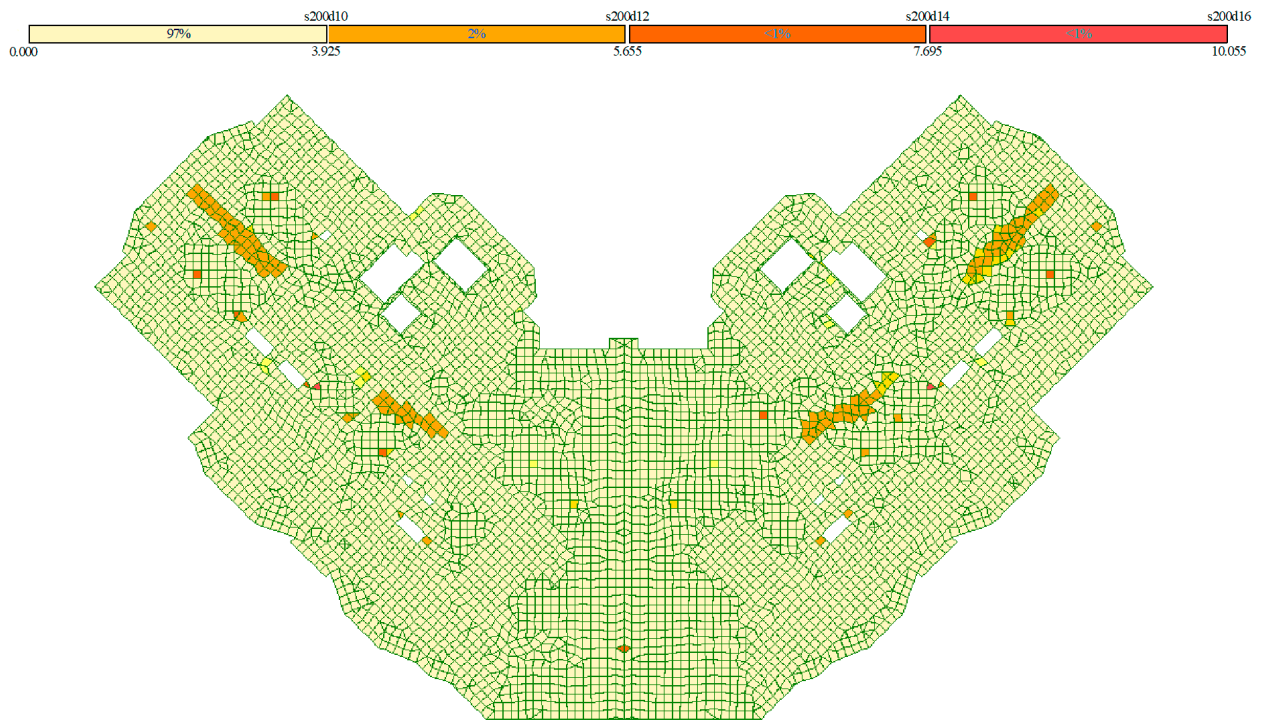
Площа арматури на 1 м. п. по осі у (нижня грань)
